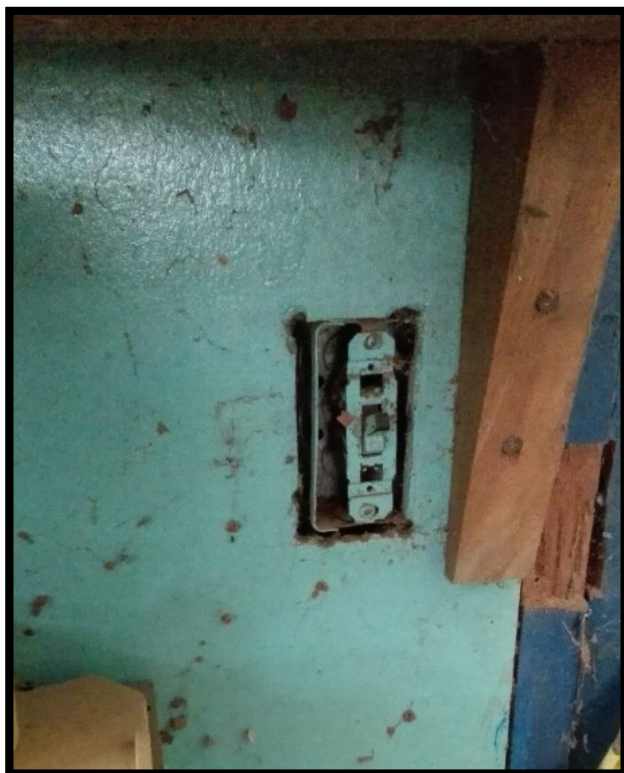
Instalaciones eléctricas de máquinas en mal estado
